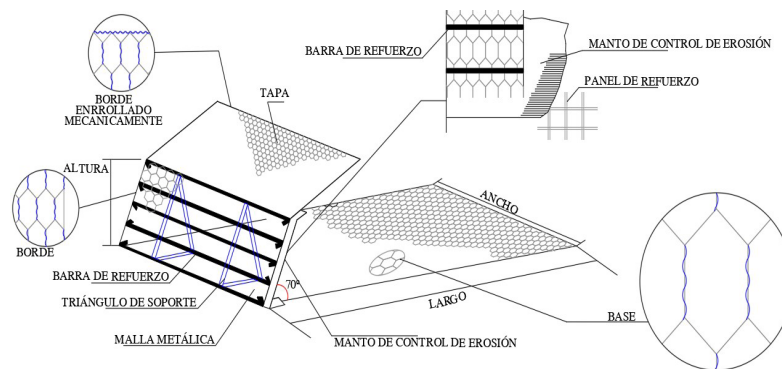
Muro reforzado con paramento inclinado y refuerzo metálico continuo.
